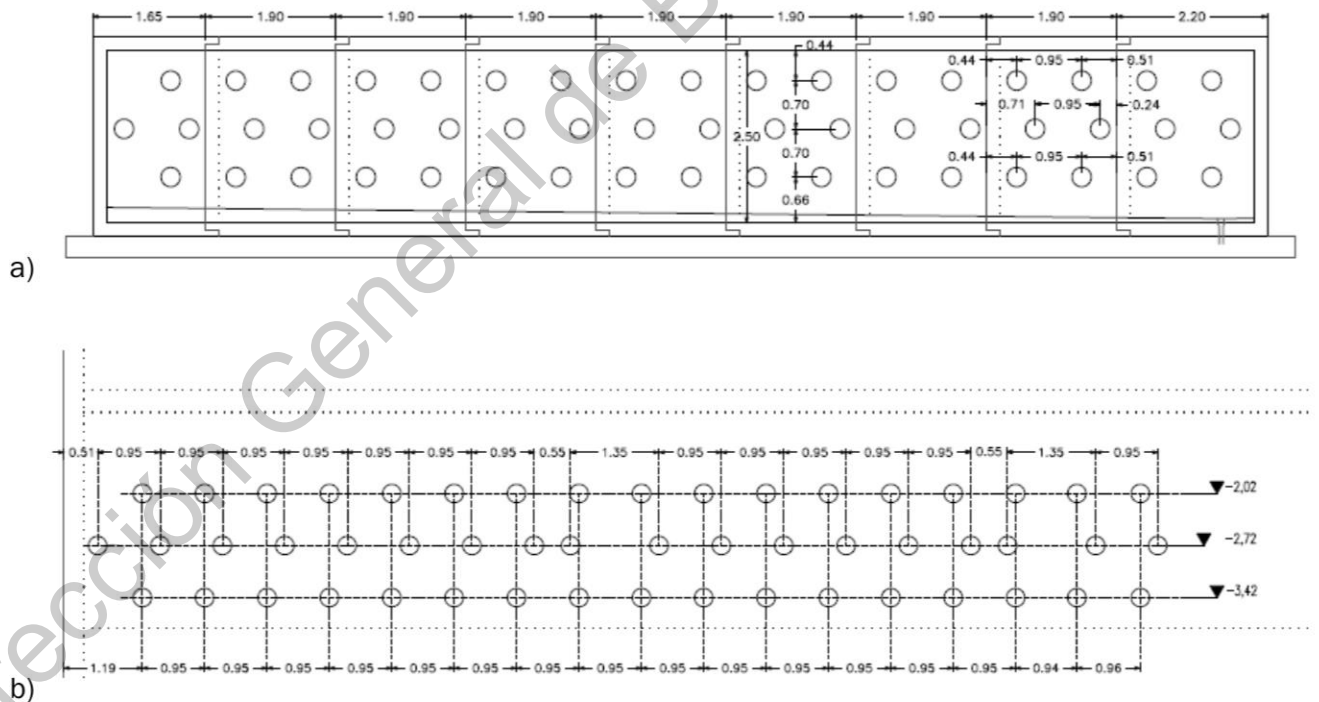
a) y b) Vista de la sección de los tubos en la galería de entrada de aire (Barbado, 2016).
